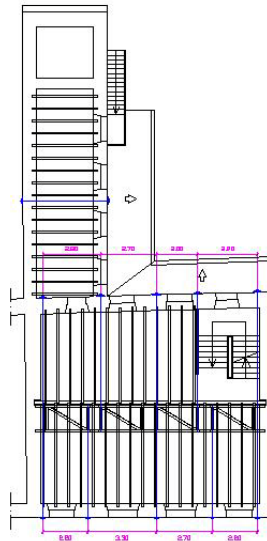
Planta do reforço estrutural da habitação da Rua Conselheiro de Medeiros, nº 42 [5]
